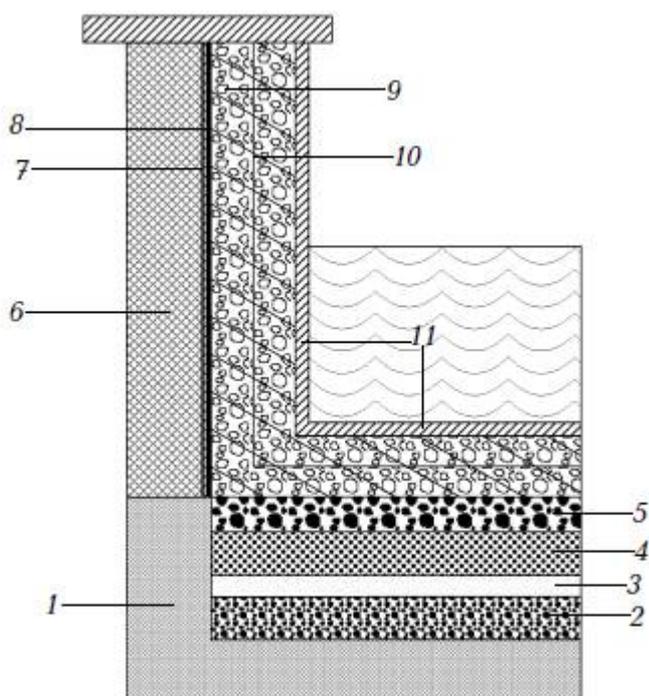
Устройство бетонного бассейна в глинистом грунте: 1) слой плотной жирной глины; 2) керамзит; 3) пенопласт; 4) песок; 5) щебень; 6) глиняный замок; 7) пленка ПВХ; 8) битумная обмазка; 9) бетонная стенка; 10) арматура; 11) цементная стяжка
